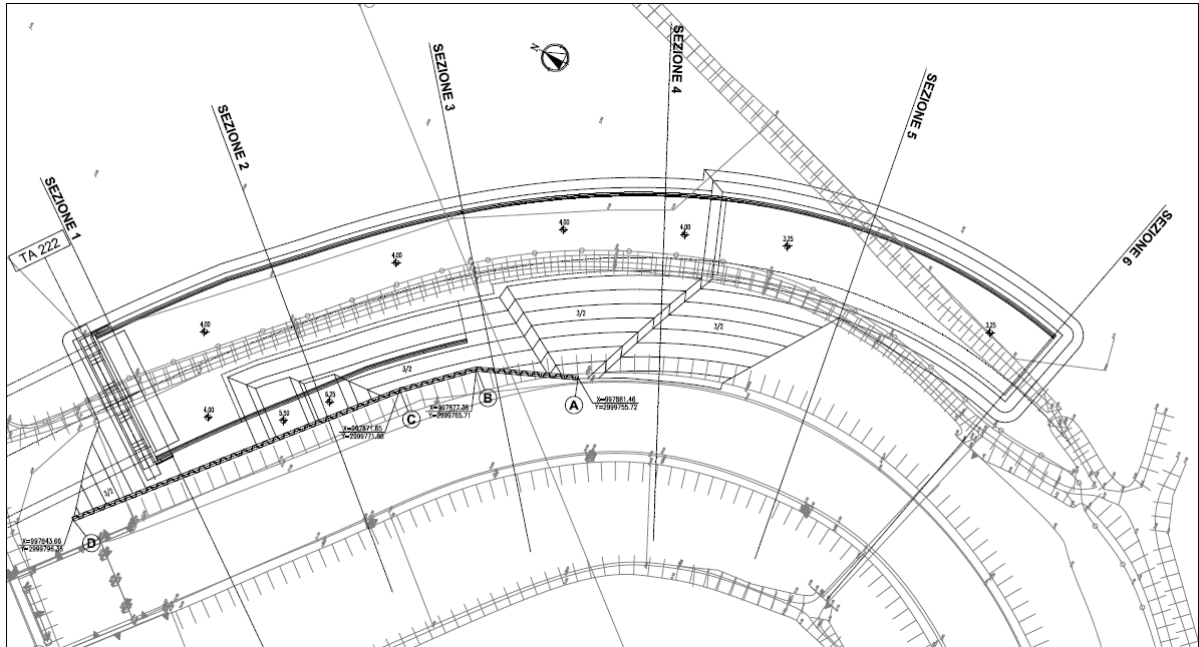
Muro TA221: sviluppo in pianta palancola e prospetto
